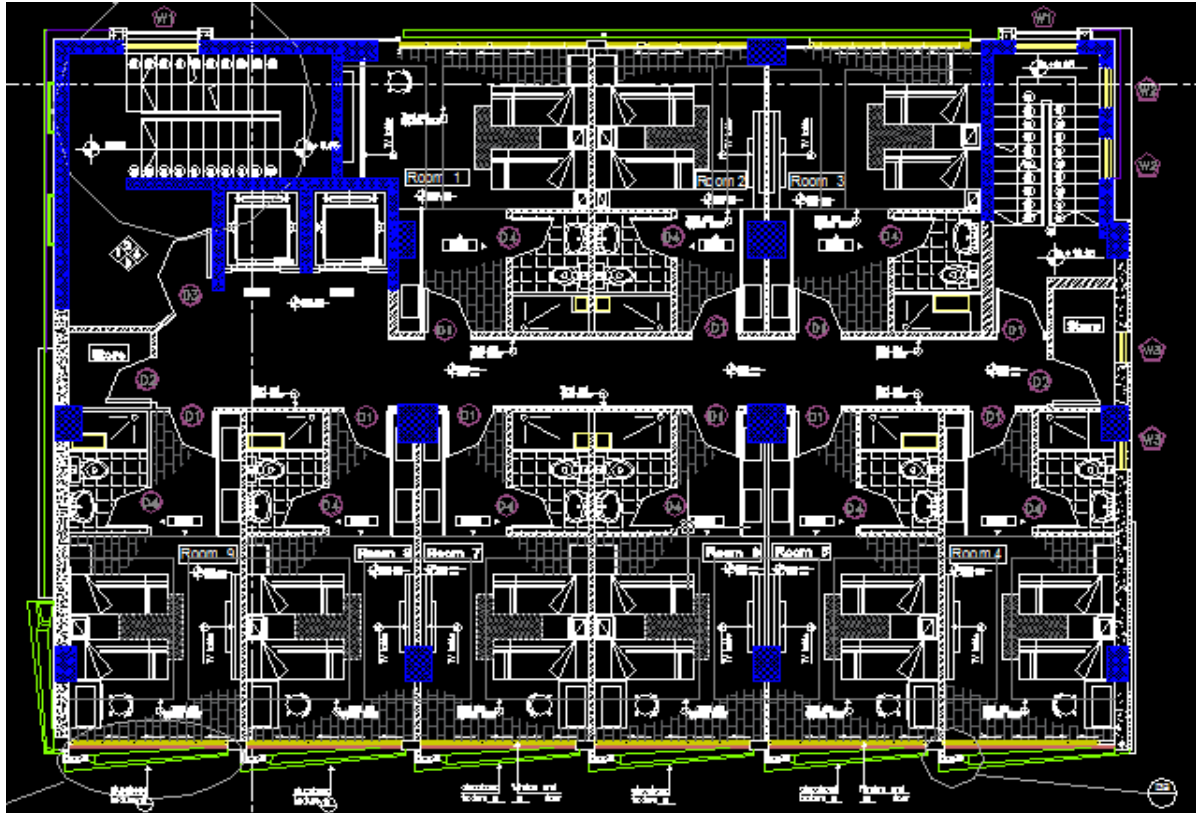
مسقط الطابق الأول والثاني والخامس والسادس مكرر.
